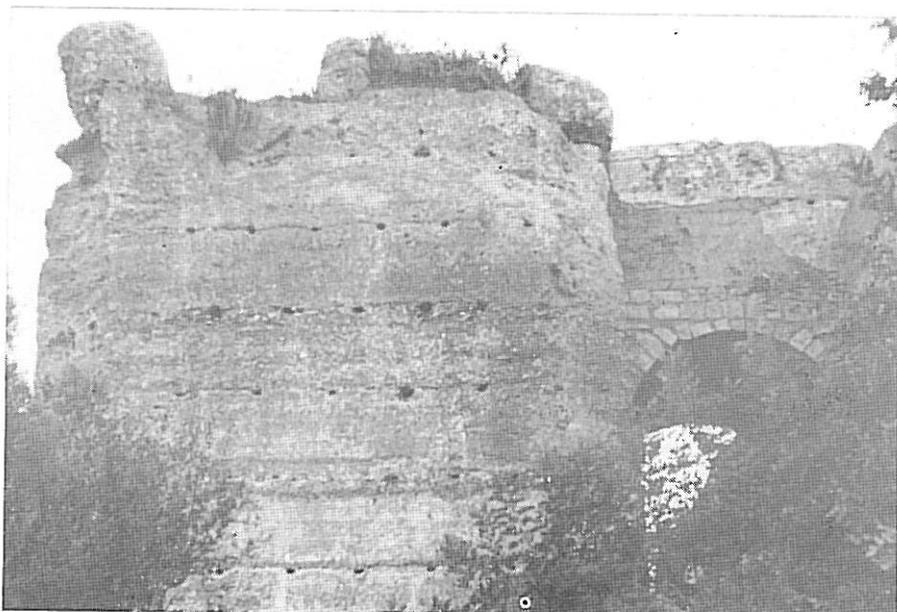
Castelo de Paderne. Pormenor da torre albarrã e ligação à muralha.
